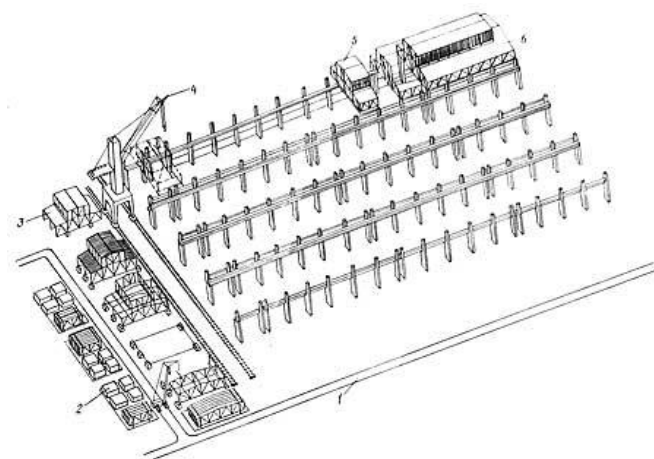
Схема блочного монтажа конструкций покрытия промышленного здания
